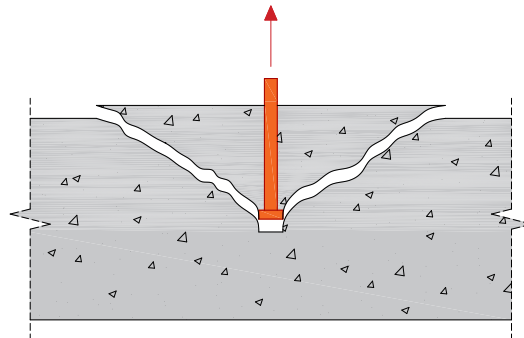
Rotura da ancoragem à tração - 2º modo: arrancamento de cone de betão.
